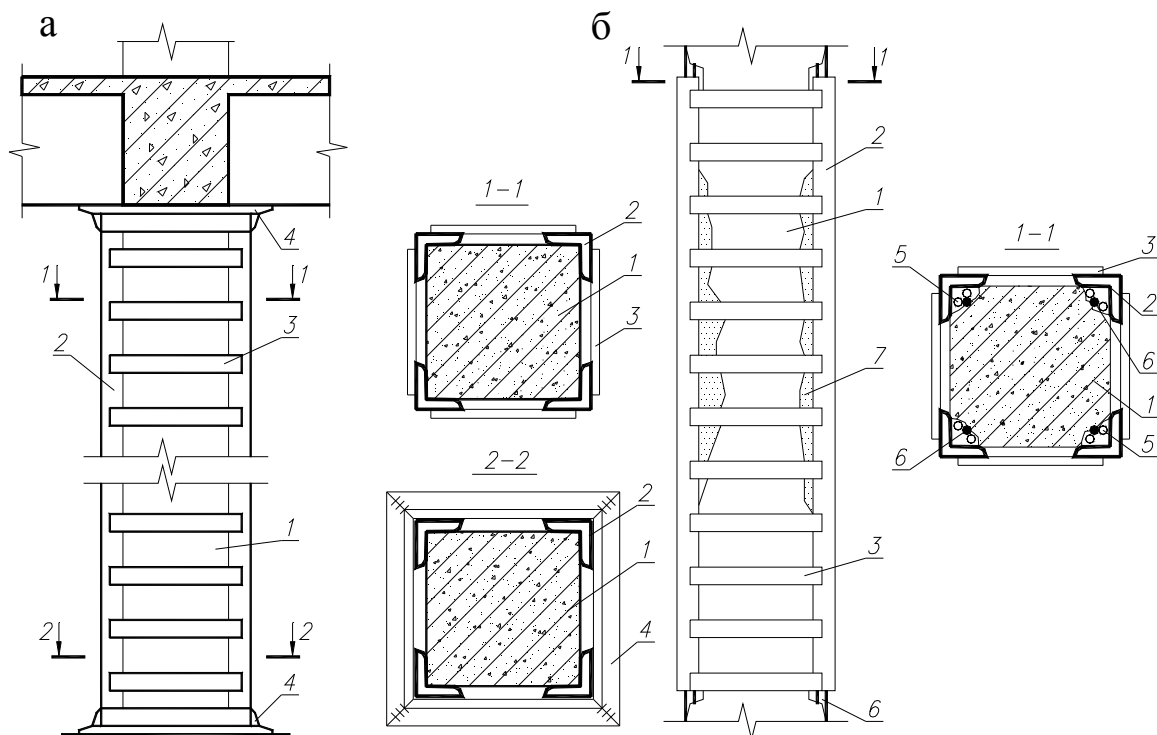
Усиление сжатых конструкций: а – стальной распоркой; б – местной стальной распоркой; 1 – усиливаемая колонна, 2 – уголок, 3 – соединительные планки, 4 – опорный уголок, 5 – коротыши, 6 – оголенная арматура, 7 – поврежденный участок
